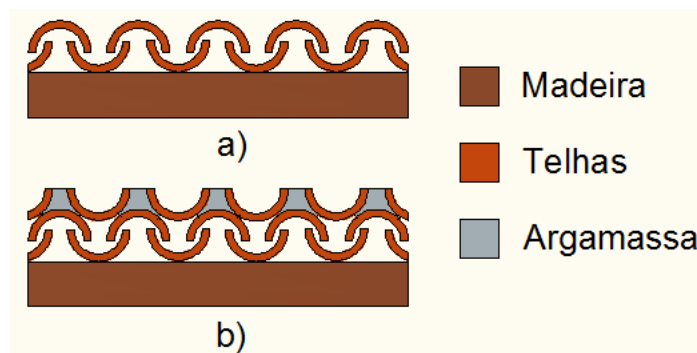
Disposição das telhas na cobertura das ermidas de habitação e capelas a), e convento b).
